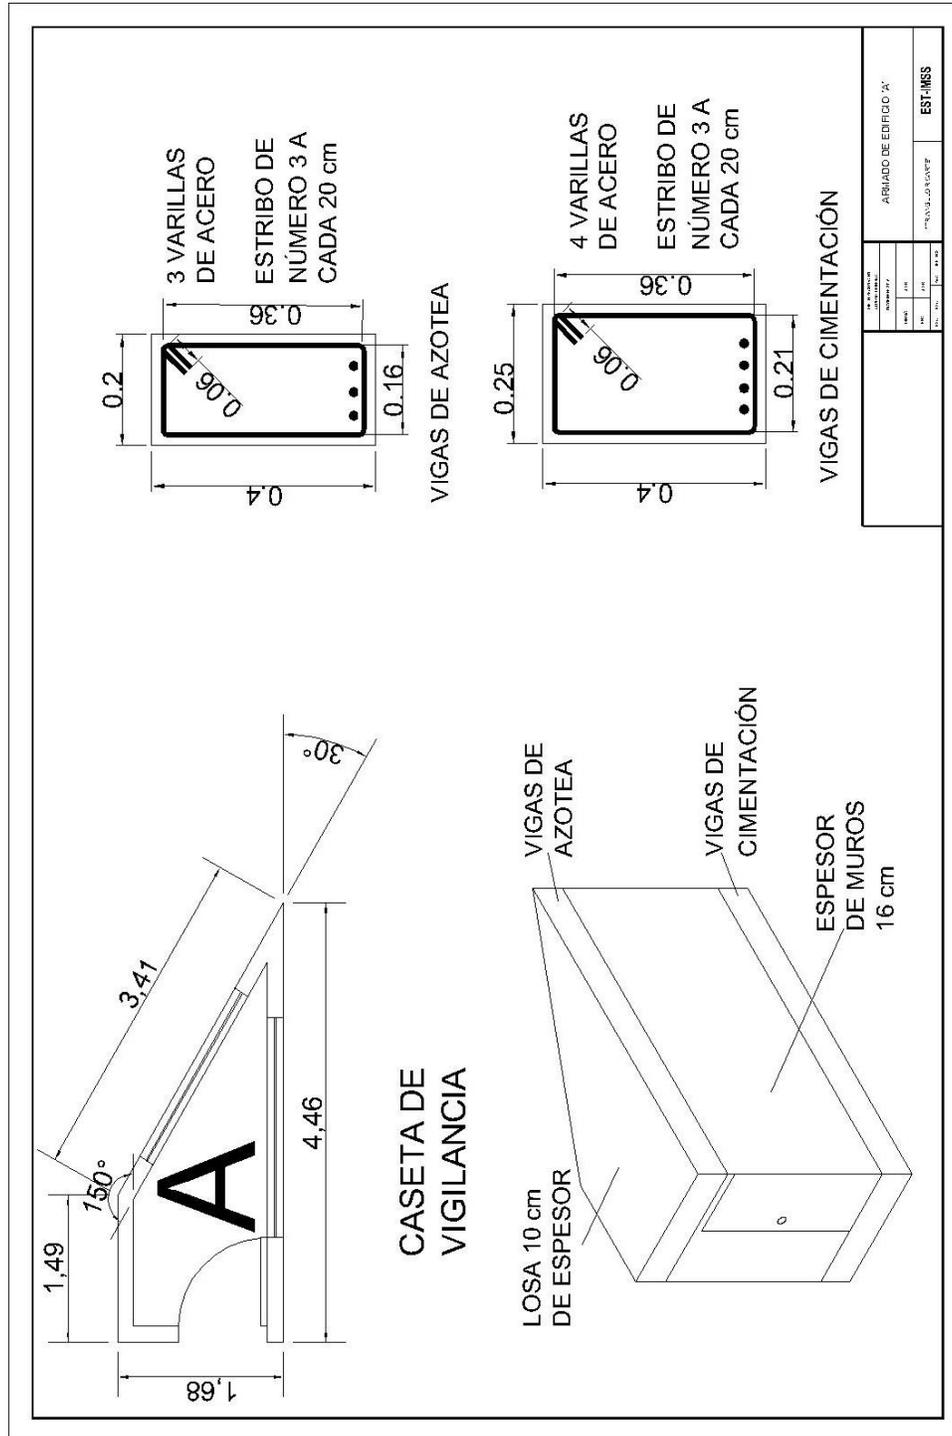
Plano de vigas de edificio "A" (fuente: dibujo hecho por el autor).
